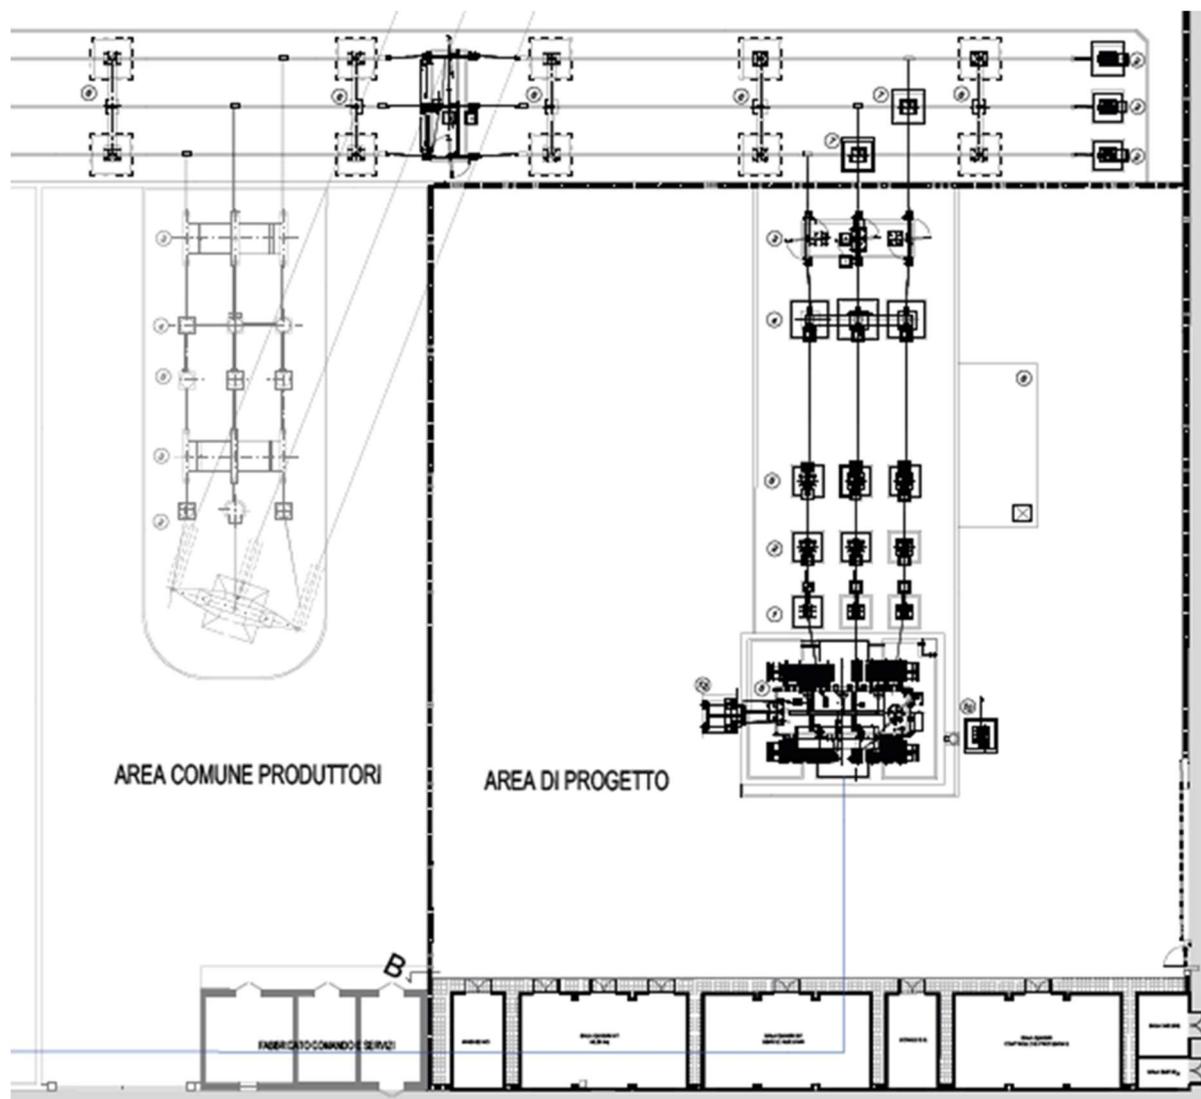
Stralcio della planimetria della Stazione utente di trasformazione 30/150 kV
